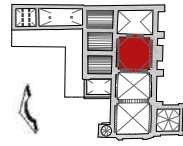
Vista general de parte baja de muro interior norte en Nave tramo 2
